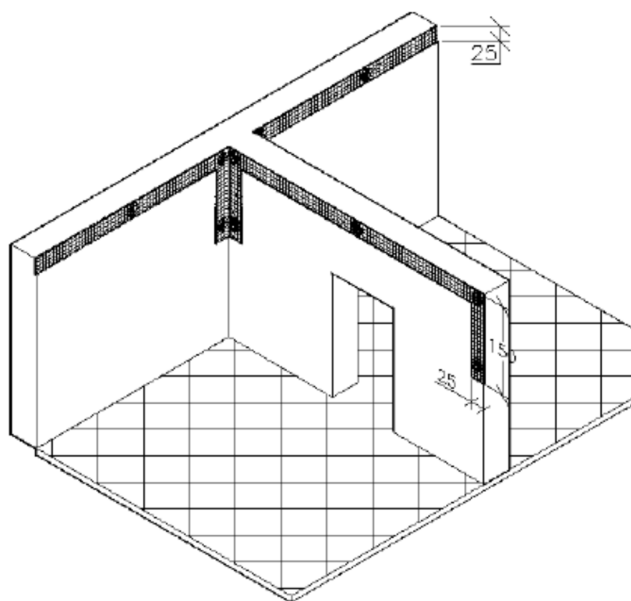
Conexión de muros perimetrales a vigas y columnas: Paso 6.
